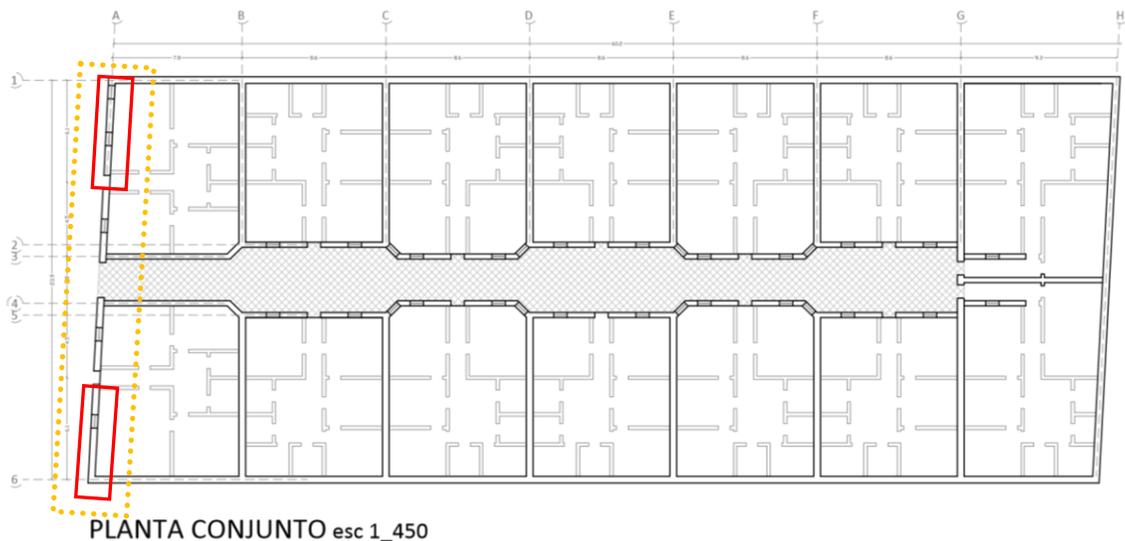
Plano de conjunto intervenido donde se indican en color rojo los muros más propensos.
